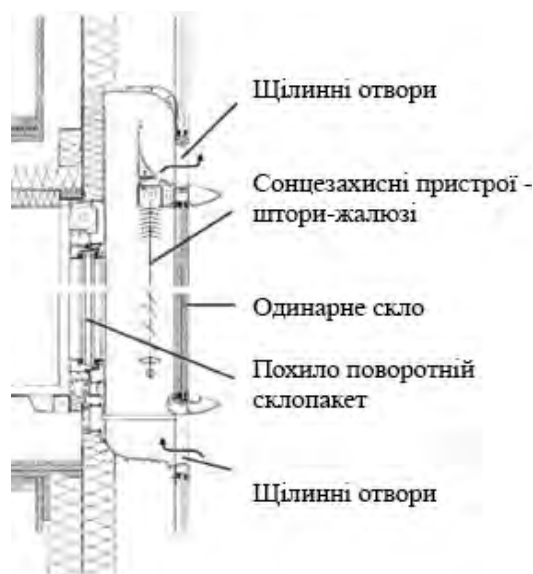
Принцип роботи подвійного вентилязованого фасаду
